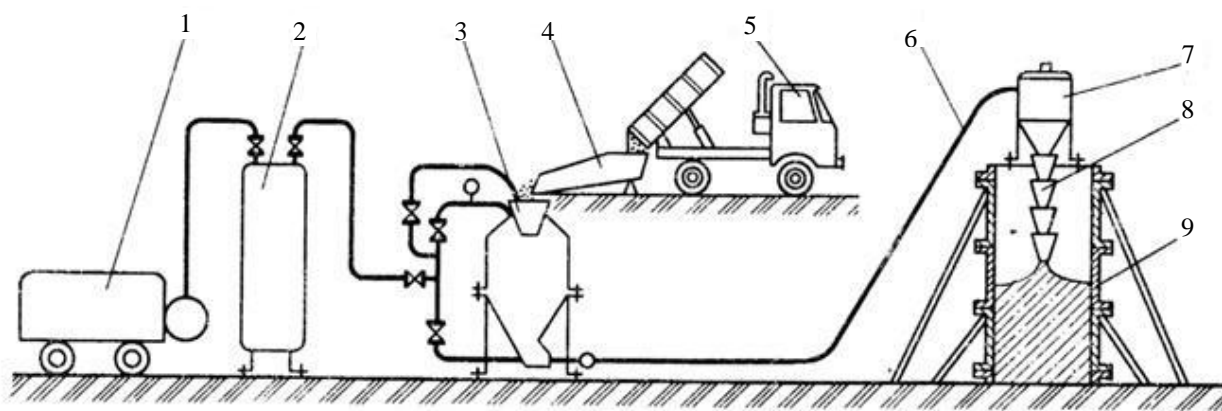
Схема бетонування за допомогою пневматичного нагнітача: 1 – компресор; 2 – ресивер; 3 – пневматичний нагнітач; 4 – віброживильник; 5 – автобетоновоз; 6 – бетоновод; 7 – гасник; 8 – хобот; 9 – опалубка
